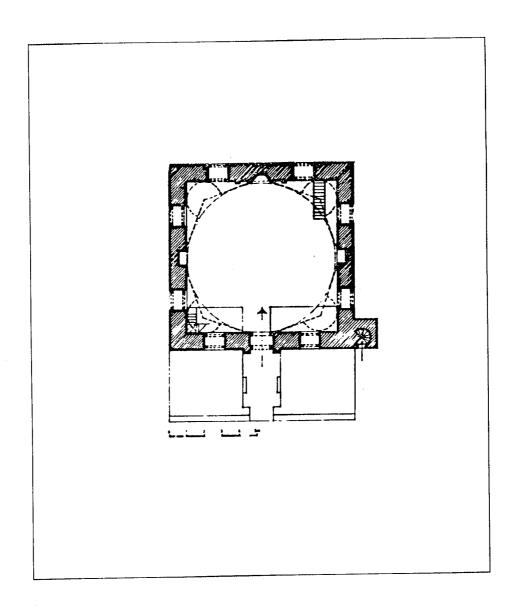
مسقط أفقي لدار الحديث في أدرنة (عن : اصلان ابا) .
